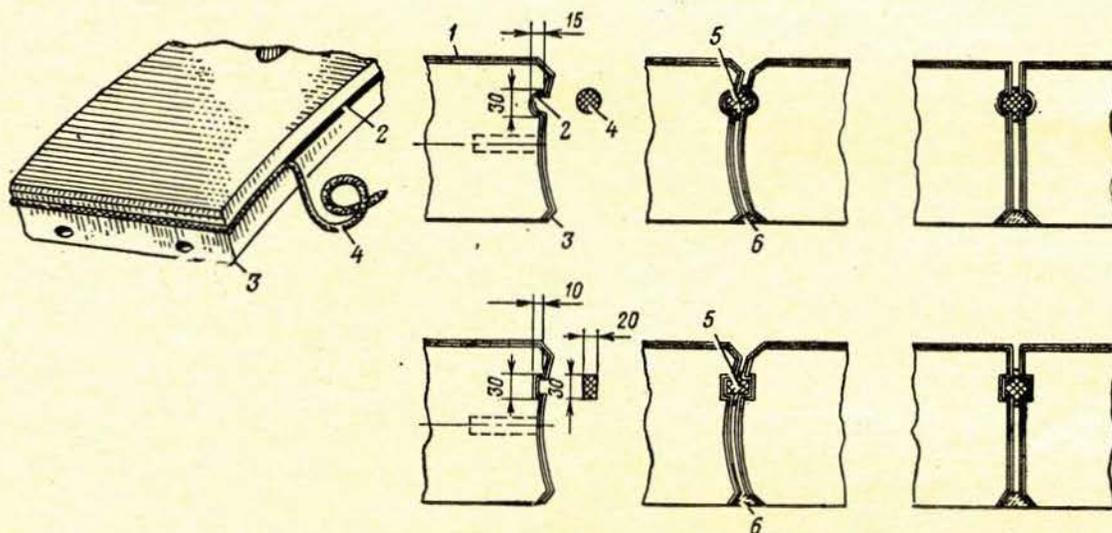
Конструктивно-технологическая схема герметизации швов железобетонной обделки тоннеля прокладкой БУТЭПРОЛ-2 круглой (сверху) и прямоугольной (снизу):
